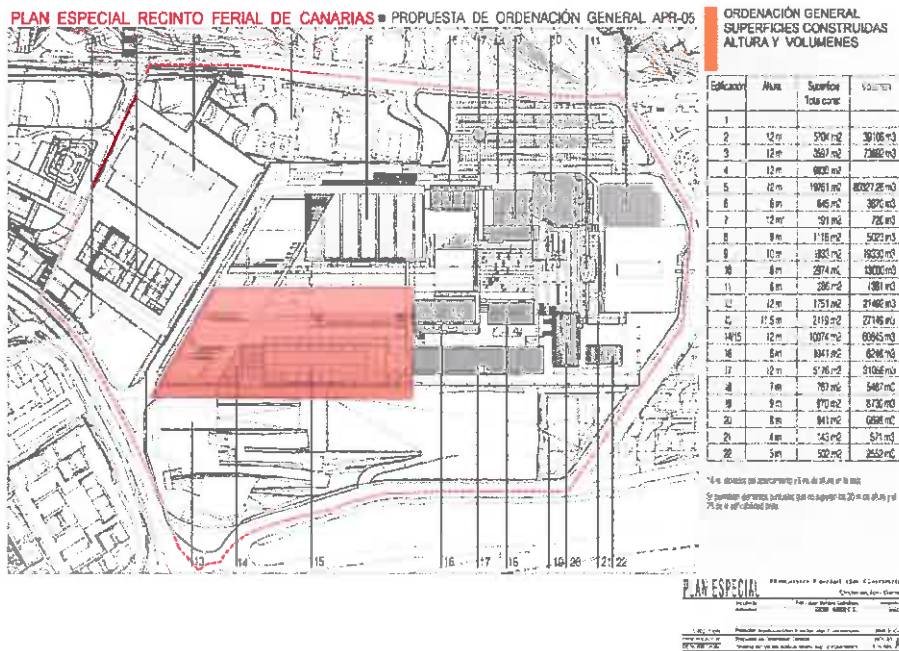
Plano de situación respecto al Plano de Ordenación General del Plan Especial del Recinto Ferial
